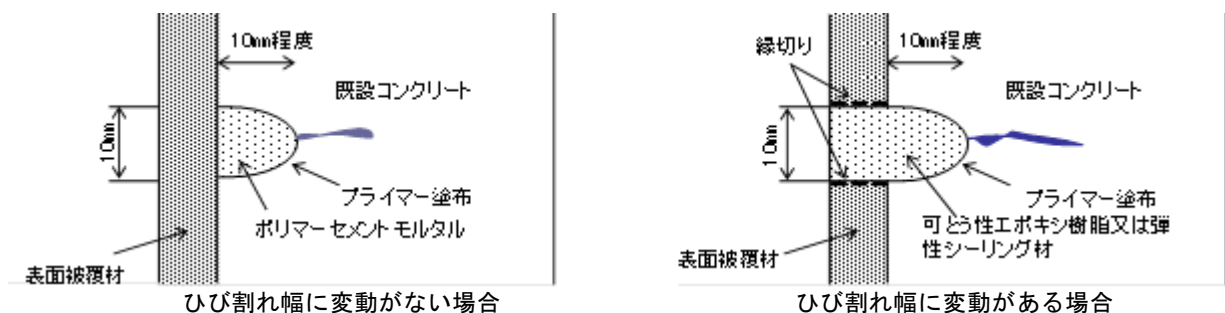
無機系被覆工法とひび割れ充填工法を併用する場合の施工事例
